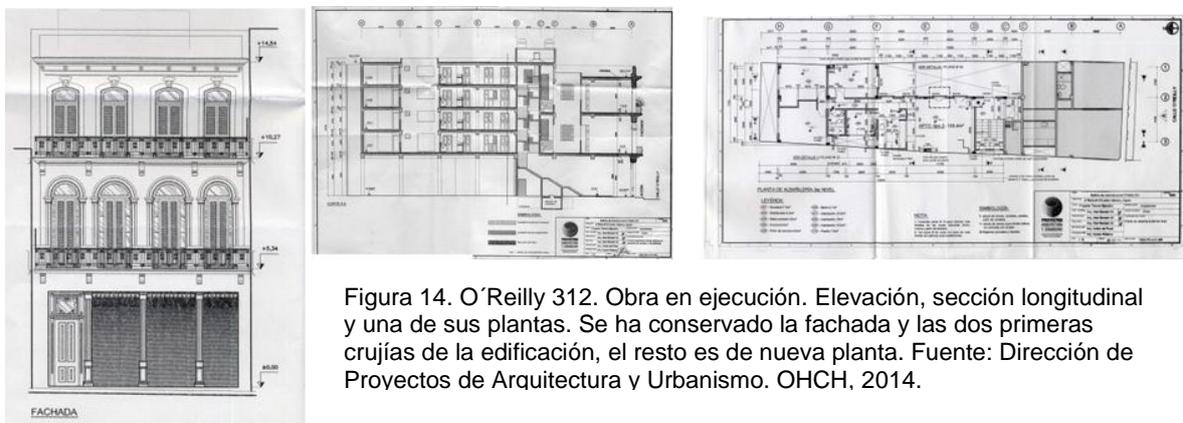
O'Reilly 312. Obra en ejecución. Elevación, sección longitudinal y una de sus plantas. Se ha conservado la fachada y las dos primeras crujiás de la edificación, el resto es de nueva planta. Fuente: Dirección de Proyectos de Arquitectura y Urbanismo. OHCH, 2014.
